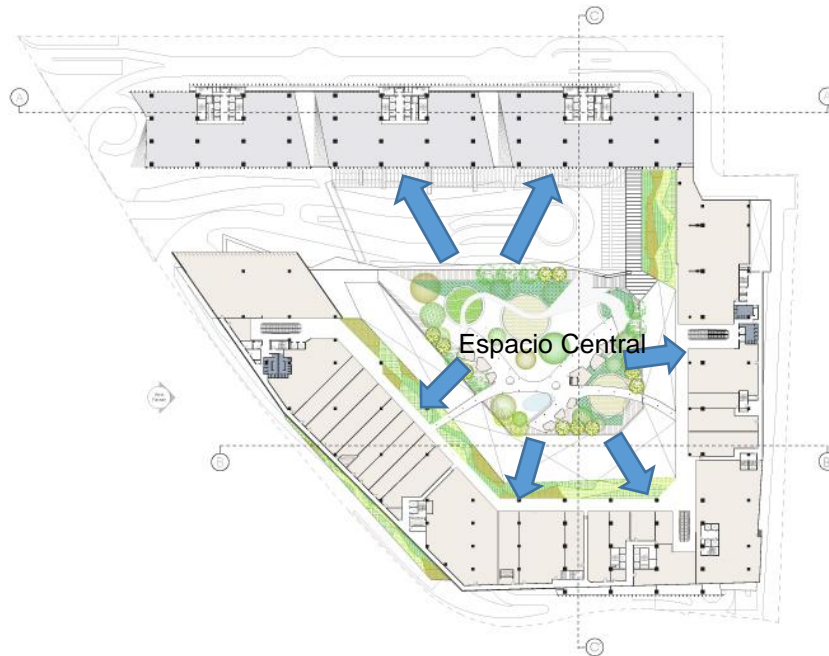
Plano de distribución 2da planta. Elaboración propia y recuperado de: www.archdaily.com
